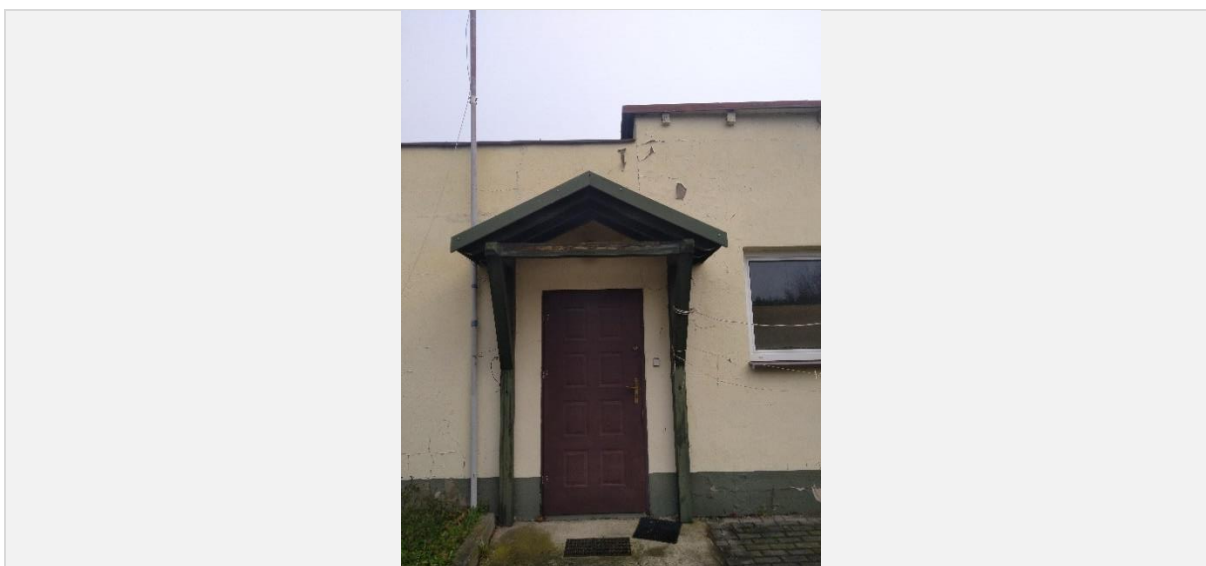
Elewacja frontowa - przybliżenie (rys.23) na największe uszkodzenia w tej części budynku
